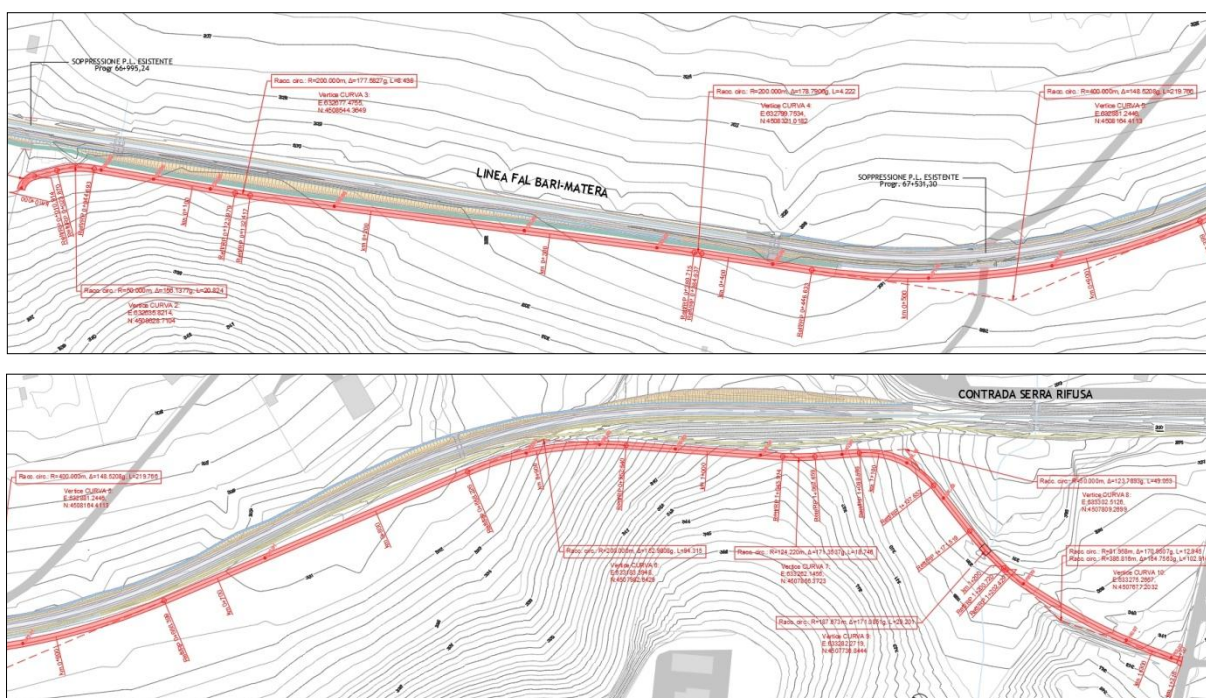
Planimetria strada poderale di progetto della connessione alla viabilità esistente
